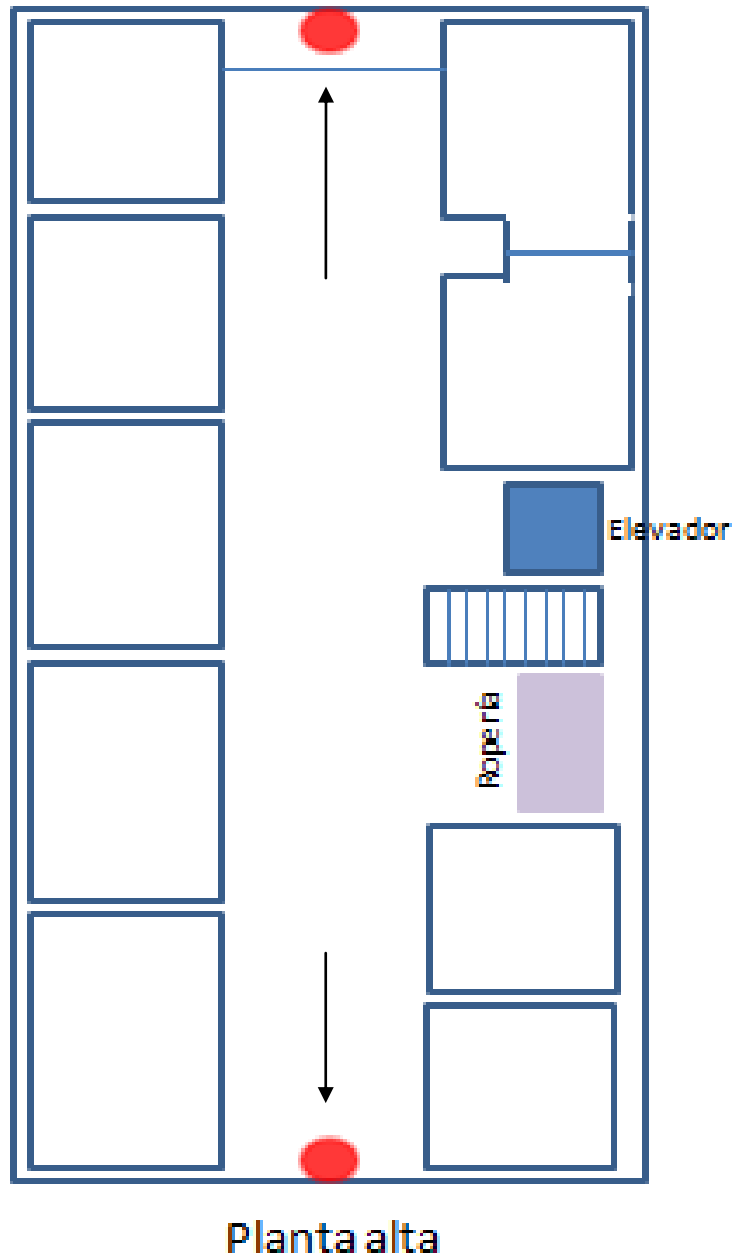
Ubicación propuesta de detectores en la planta alta, situados al fondo del pasillo
